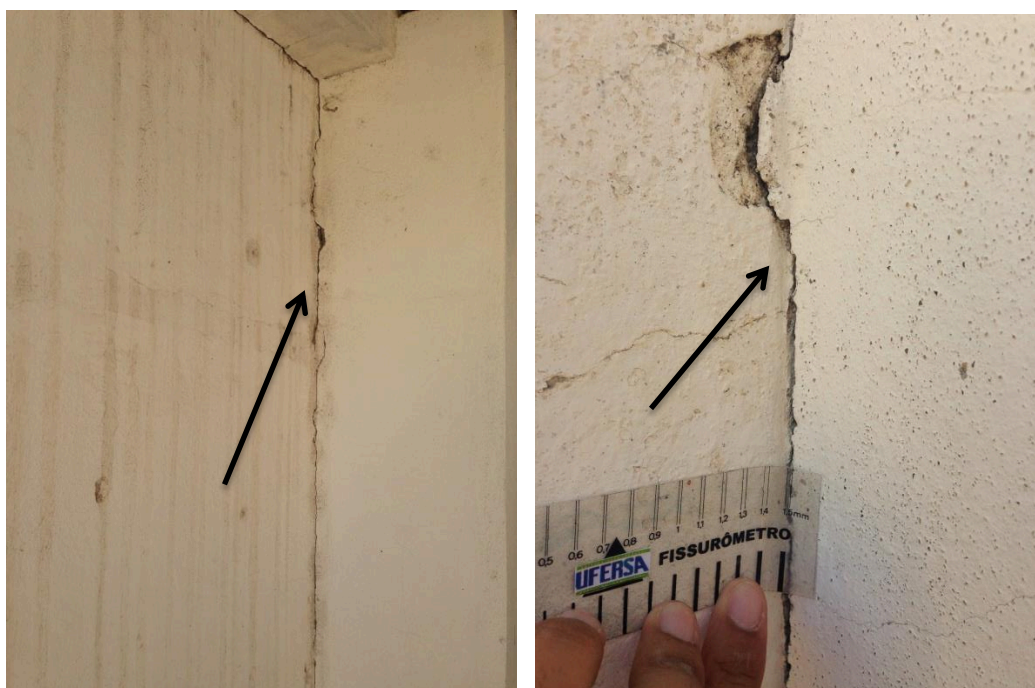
Fissura causada por Detalhes construtivos
